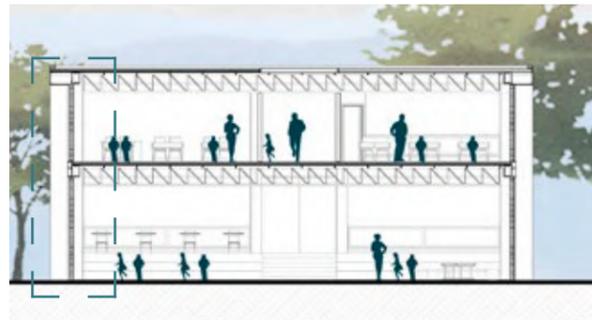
| Sistema constructivo aulario escuela/ mantenimiento | Fuente: Elaboración Propia
